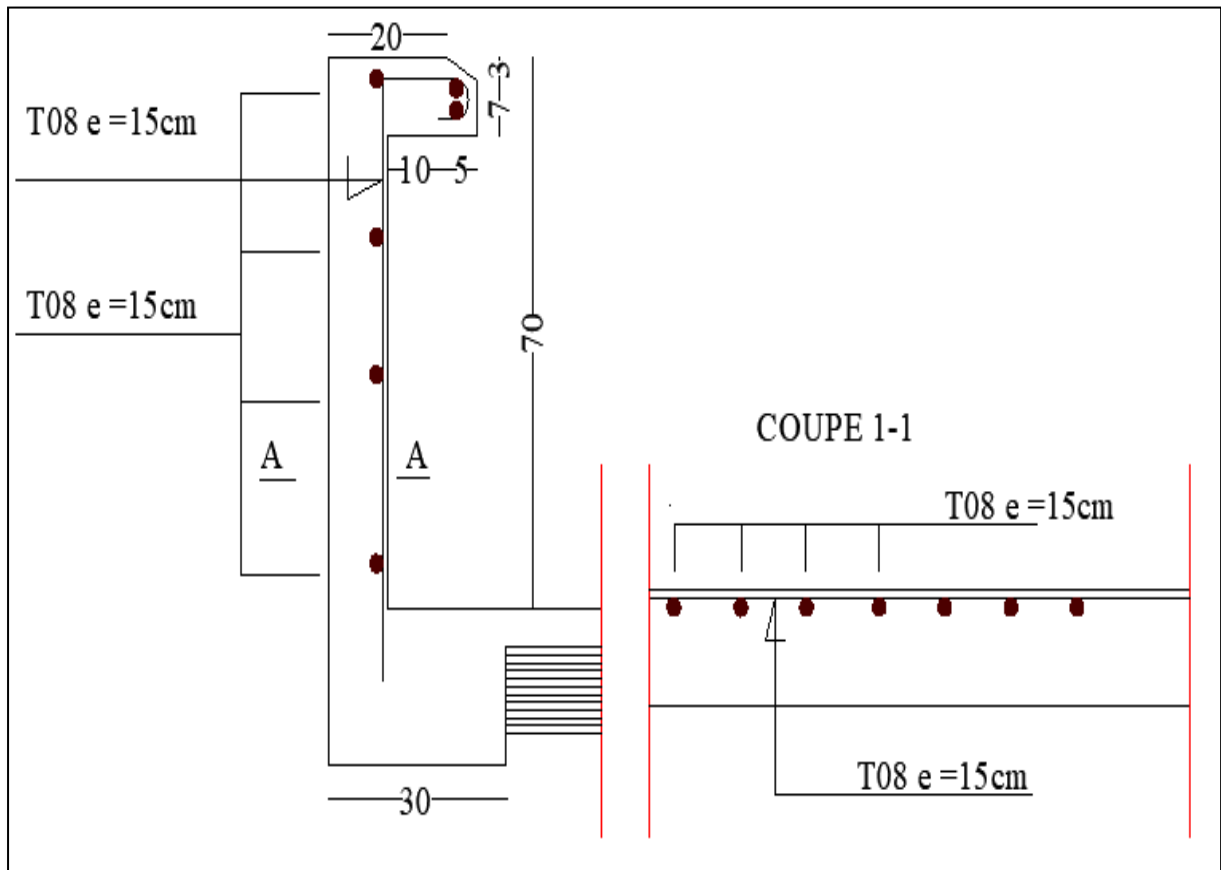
Schéma de ferrailage d'acrotère terrasse inaccessible.
